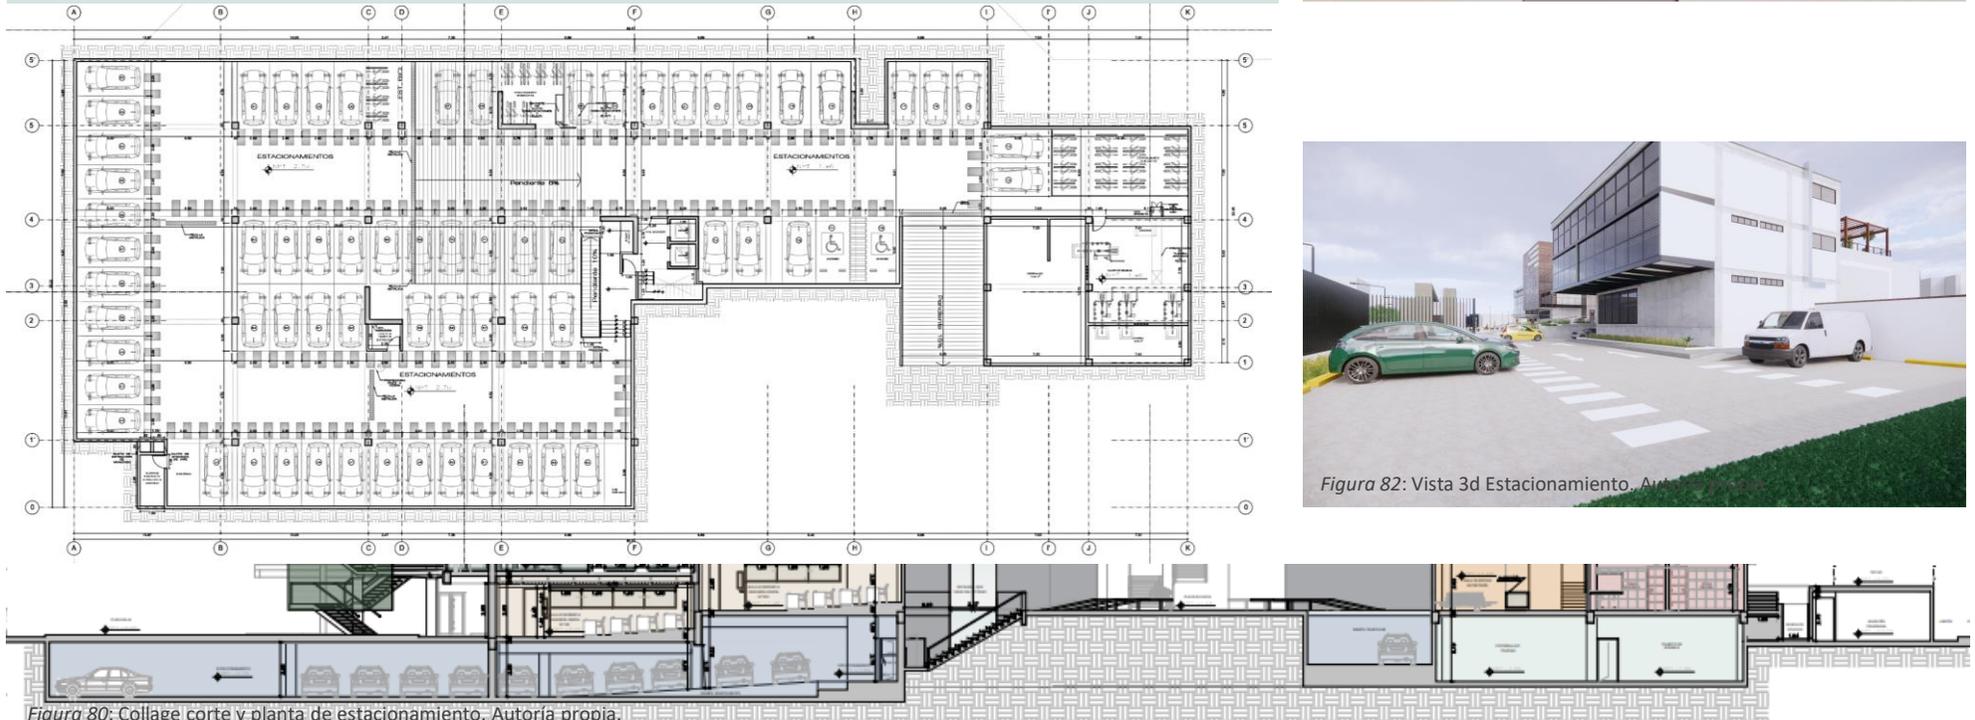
Collage corte y planta de estacionamiento. Autoría propia.
